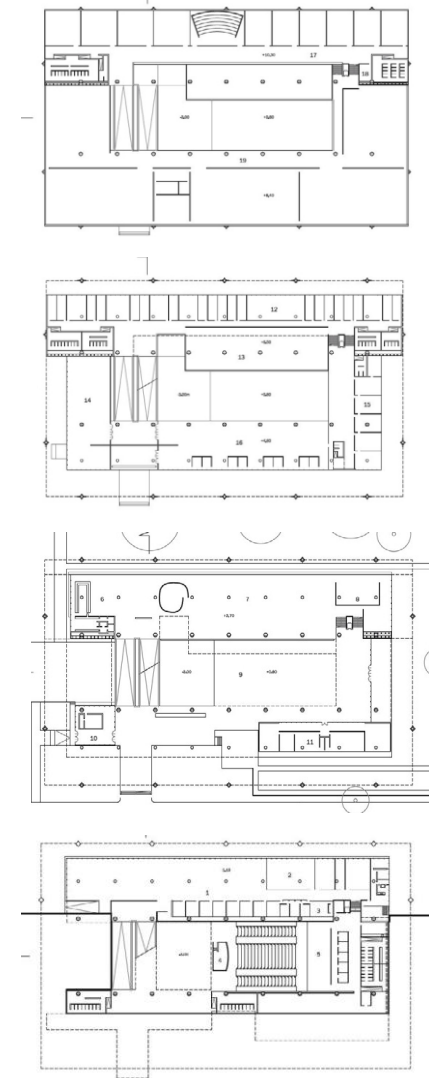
Plantas de distribución en orden ascendente, FAU.
